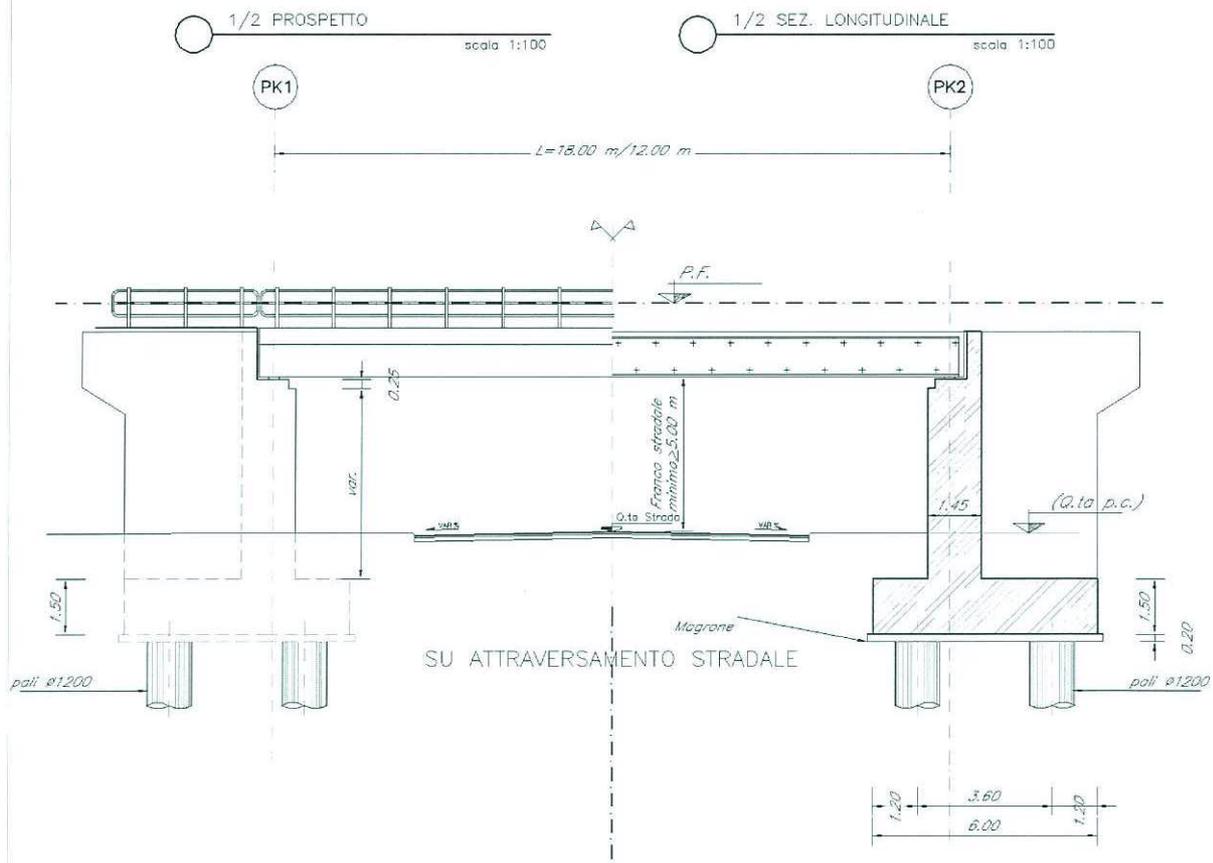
Prospetto/Sezione longitudinale in corrispondenza di attraversamento stradale.
